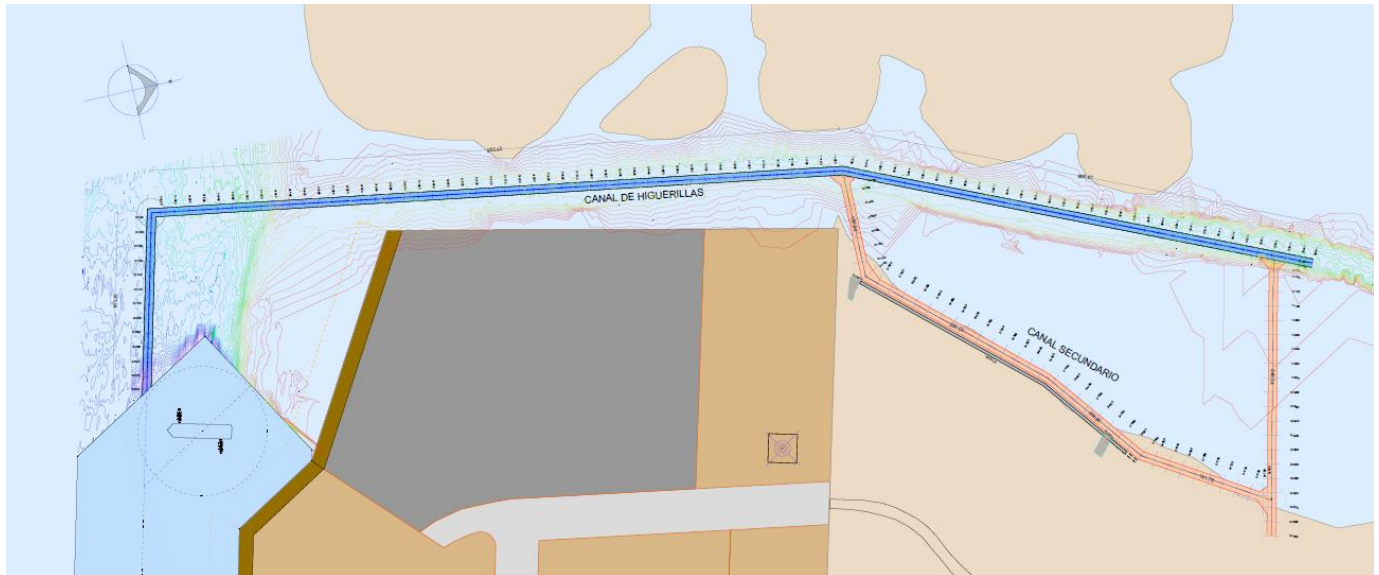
Vista en Alzado del Dimensionamiento de la Zona del canal secundario.
